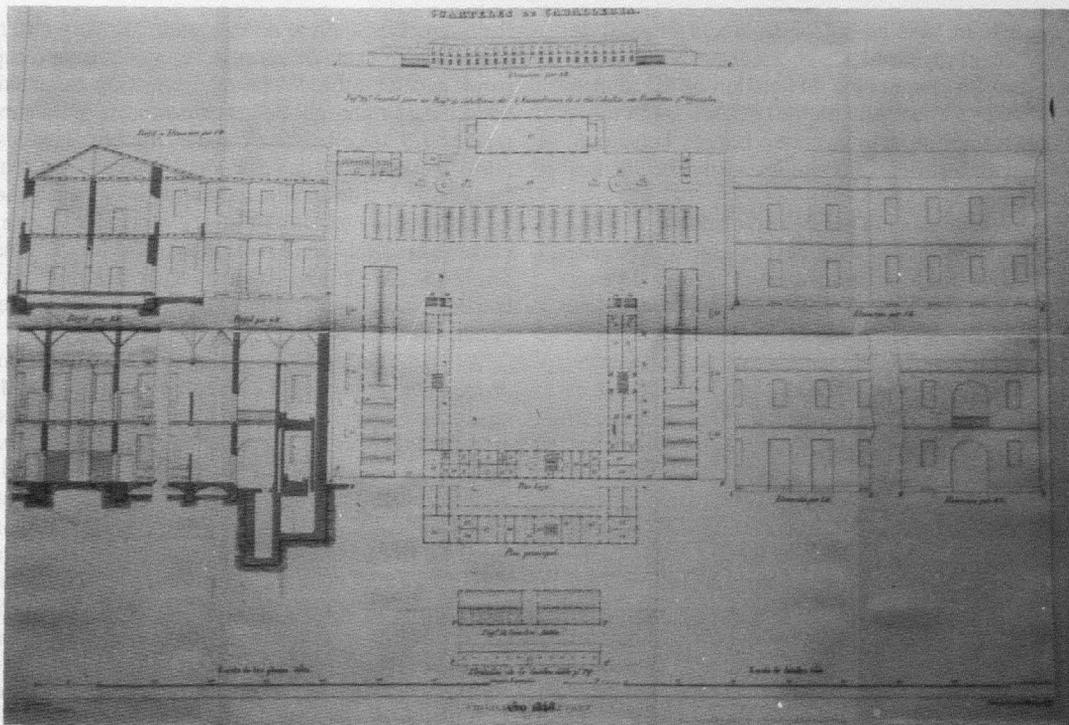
Cuarteles de Caballería: distribución de planta en U con cuadras independientes, secciones y alzados. (Memorial de Ingenieros, 1848, Lám. 13).
